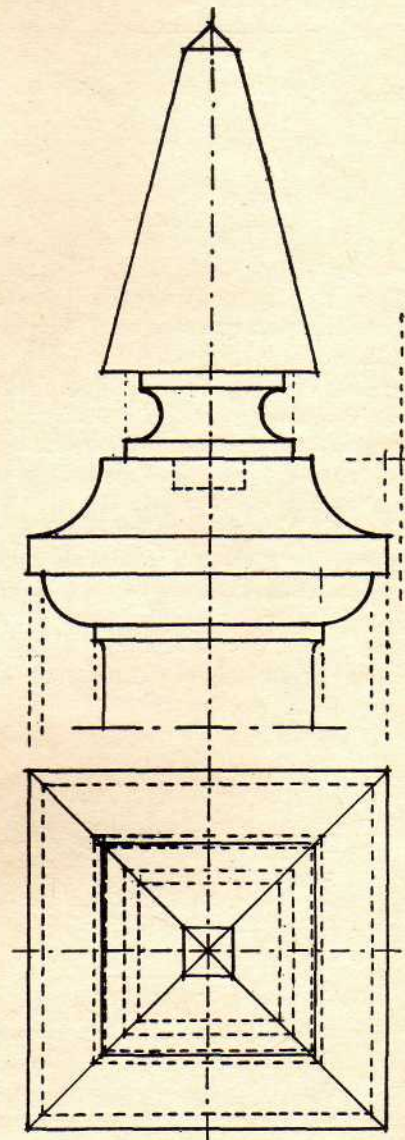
COROAMENTO DE PILAR OU COLUNA
